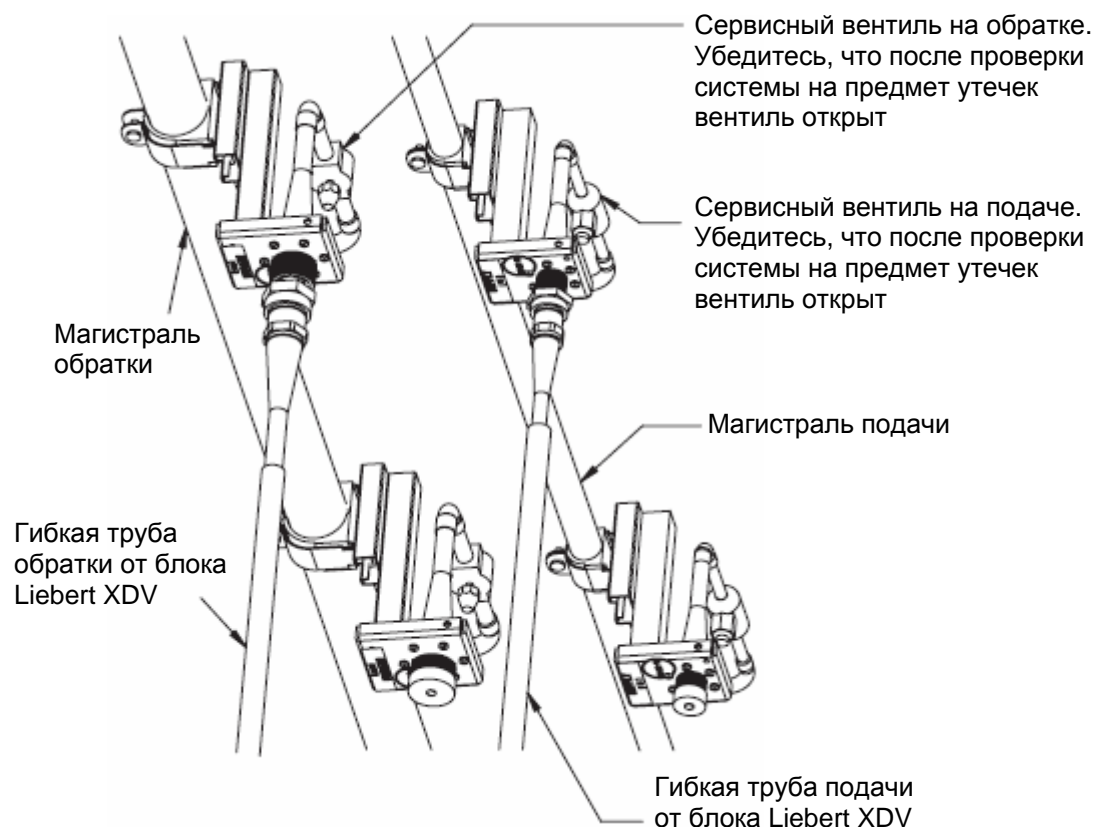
Детальный вид гибких труб Liebert XD и изготовленного заранее соединительного порта
